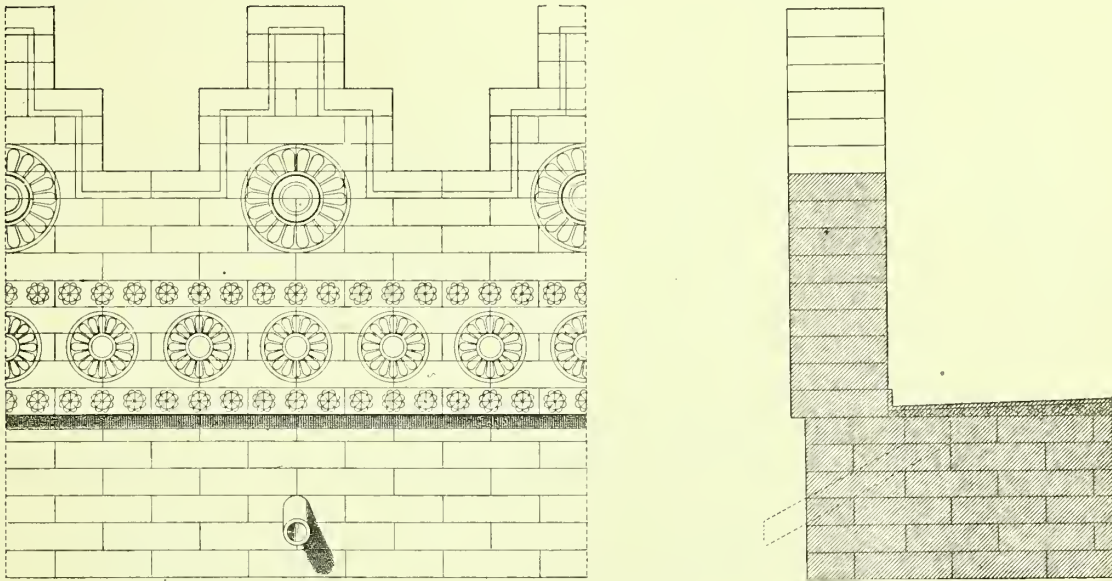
PARAPETO ALMENADO DEL ZIGURAT DE SARGÓN EN KHORSABAD. - ALZADO Y SECCIÓN (SEGÚN THOMAS)
